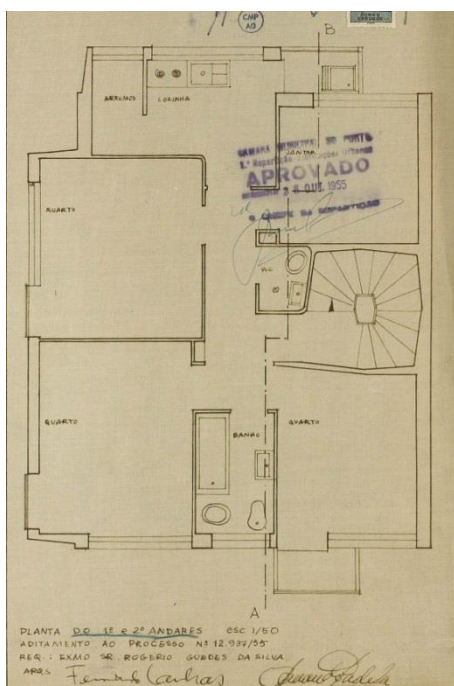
Planta do edifício nº 11 e Fig. 177. Fotografia de pormenor do edifício nº 11 em gaveto.
